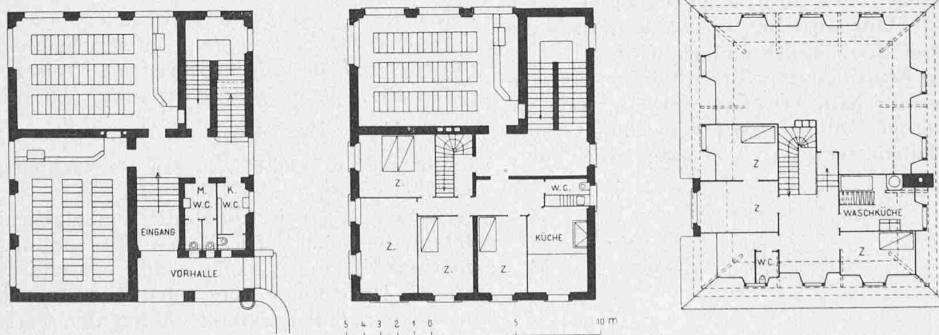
bis 3. Grundrisse des Schulhauses Avully bei Genf. — Masstab 1 : 400.
